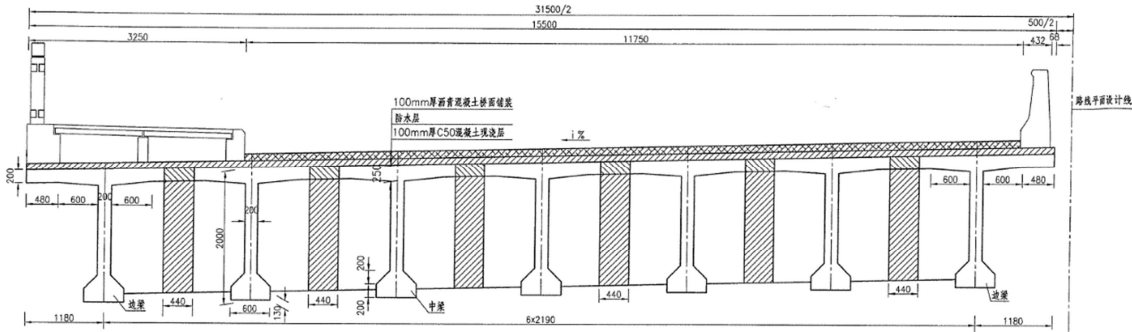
钟家湾大桥横断面布置示意图（单位：mm）。
